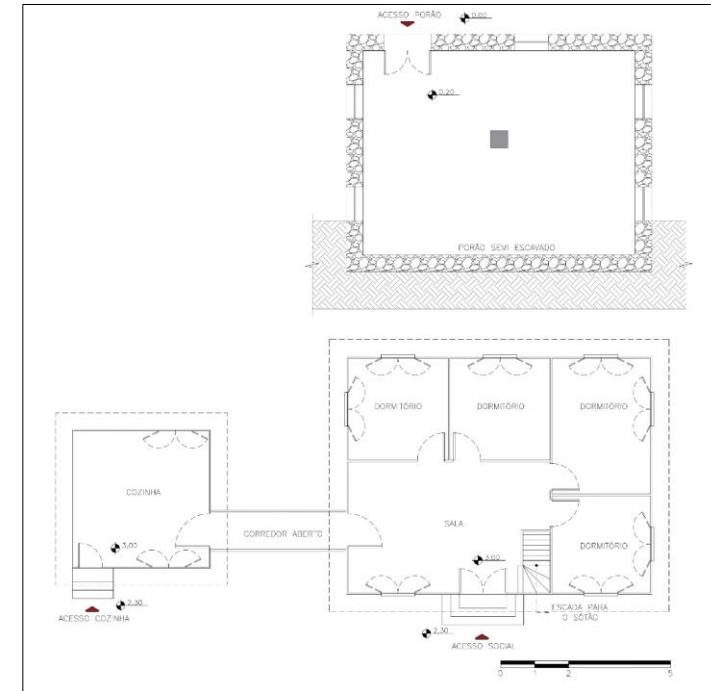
Planta baixa esquemática de uma casa típica do terceiro período. Fonte: Autores, 2021.
